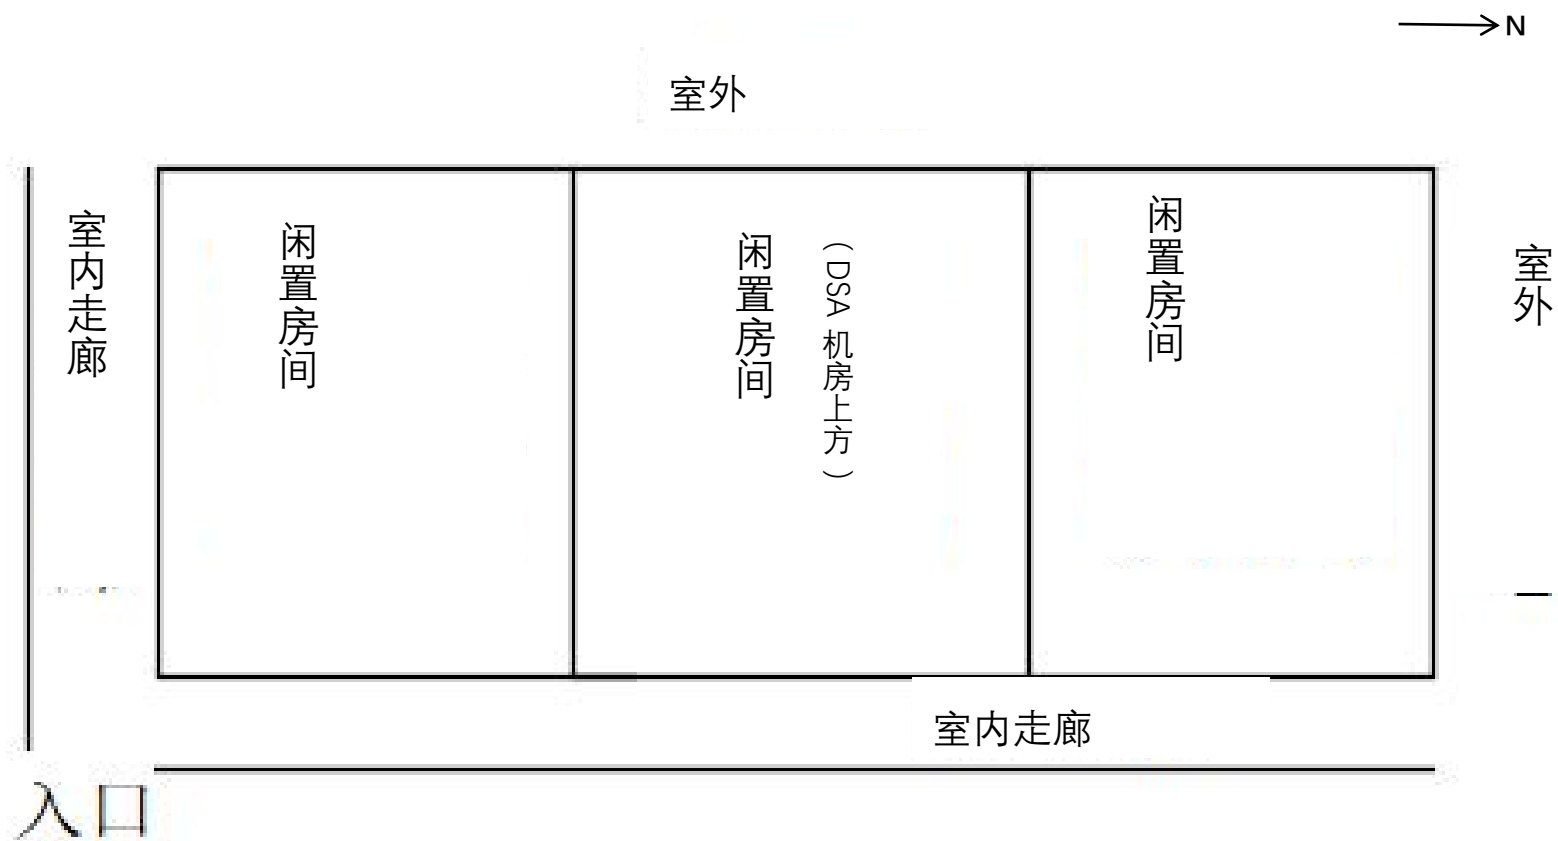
DSA 调试机房所在建筑 2 层平面布置示意图
